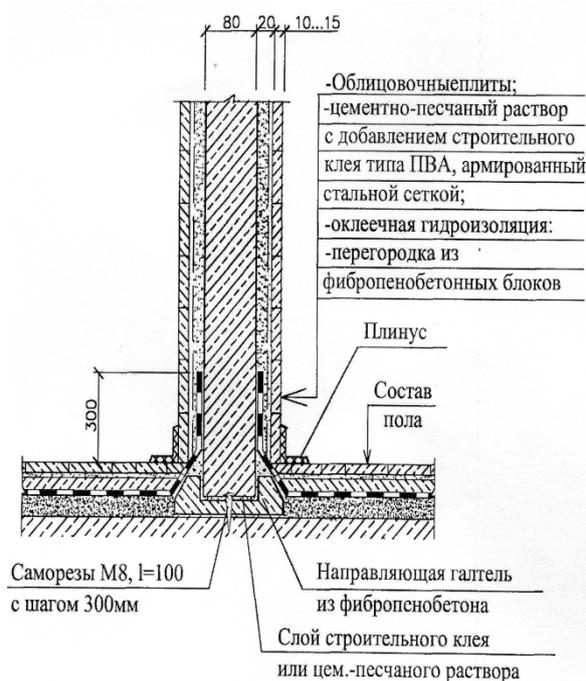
Схема перегородки из фибропенобетона для влажных помещений
